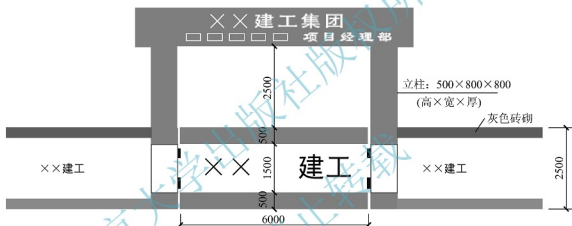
某公司有门楼式大门立面图 (单位: mm)
